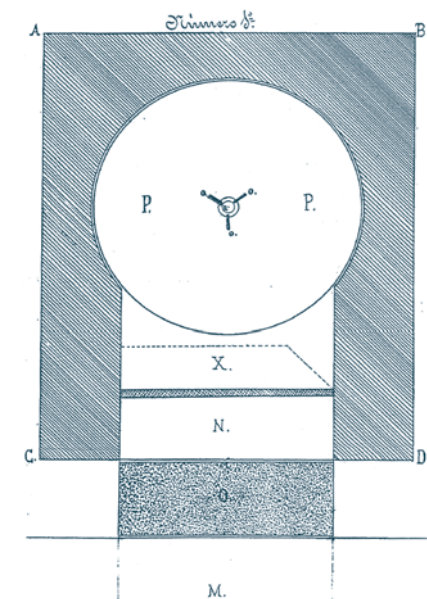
Planta del Flotador Salmerón. Plano Número 1, original de la patente.
